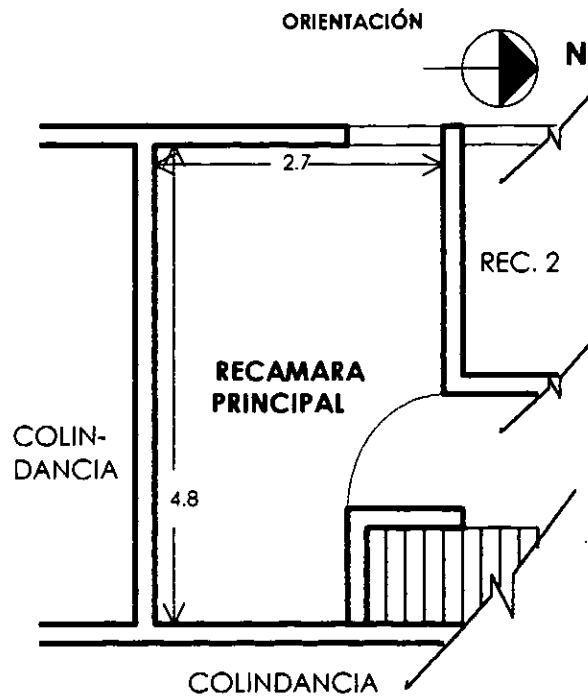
Planta arquitectónica de la habitación monitoreada.
